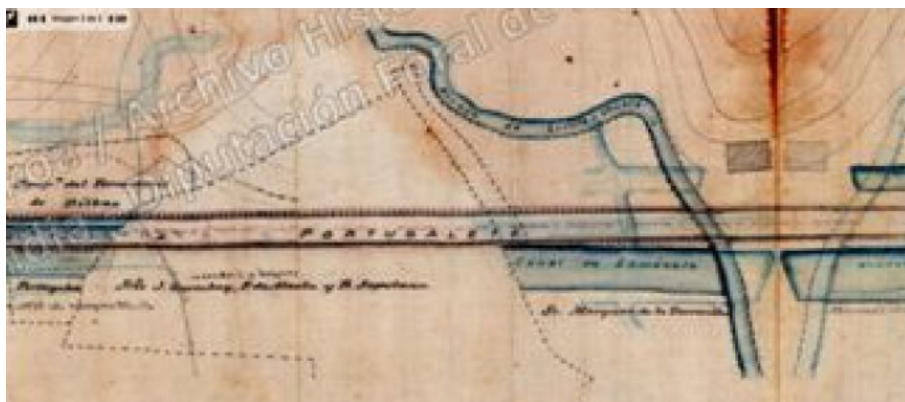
Hay una imagen en la que junto al arroyo Errotatxueta aparece el canal de Zamakola sobre el que se construyó el tendido de las vías del ferrocarril de Bilbao a Portugalete. Zona baja de la vega de Abando. Se indican propietarios de la zona. Pertenecen al expediente incoado por el Ayuntamiento para averiguar a quién le corresponde terminar con las aguas estancadas que se están produciendo a causa de haber destruido los antiguos desagües de la zona durante las obras de construcción de ferrocarril y de relleno de la vega.
